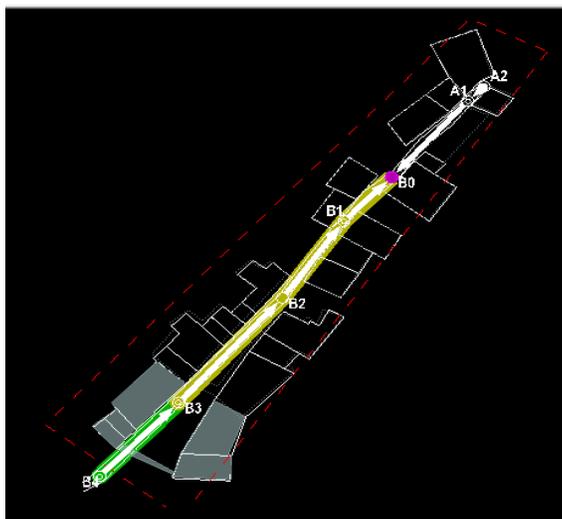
Aldea La Vega elaborado en SewerUp.
